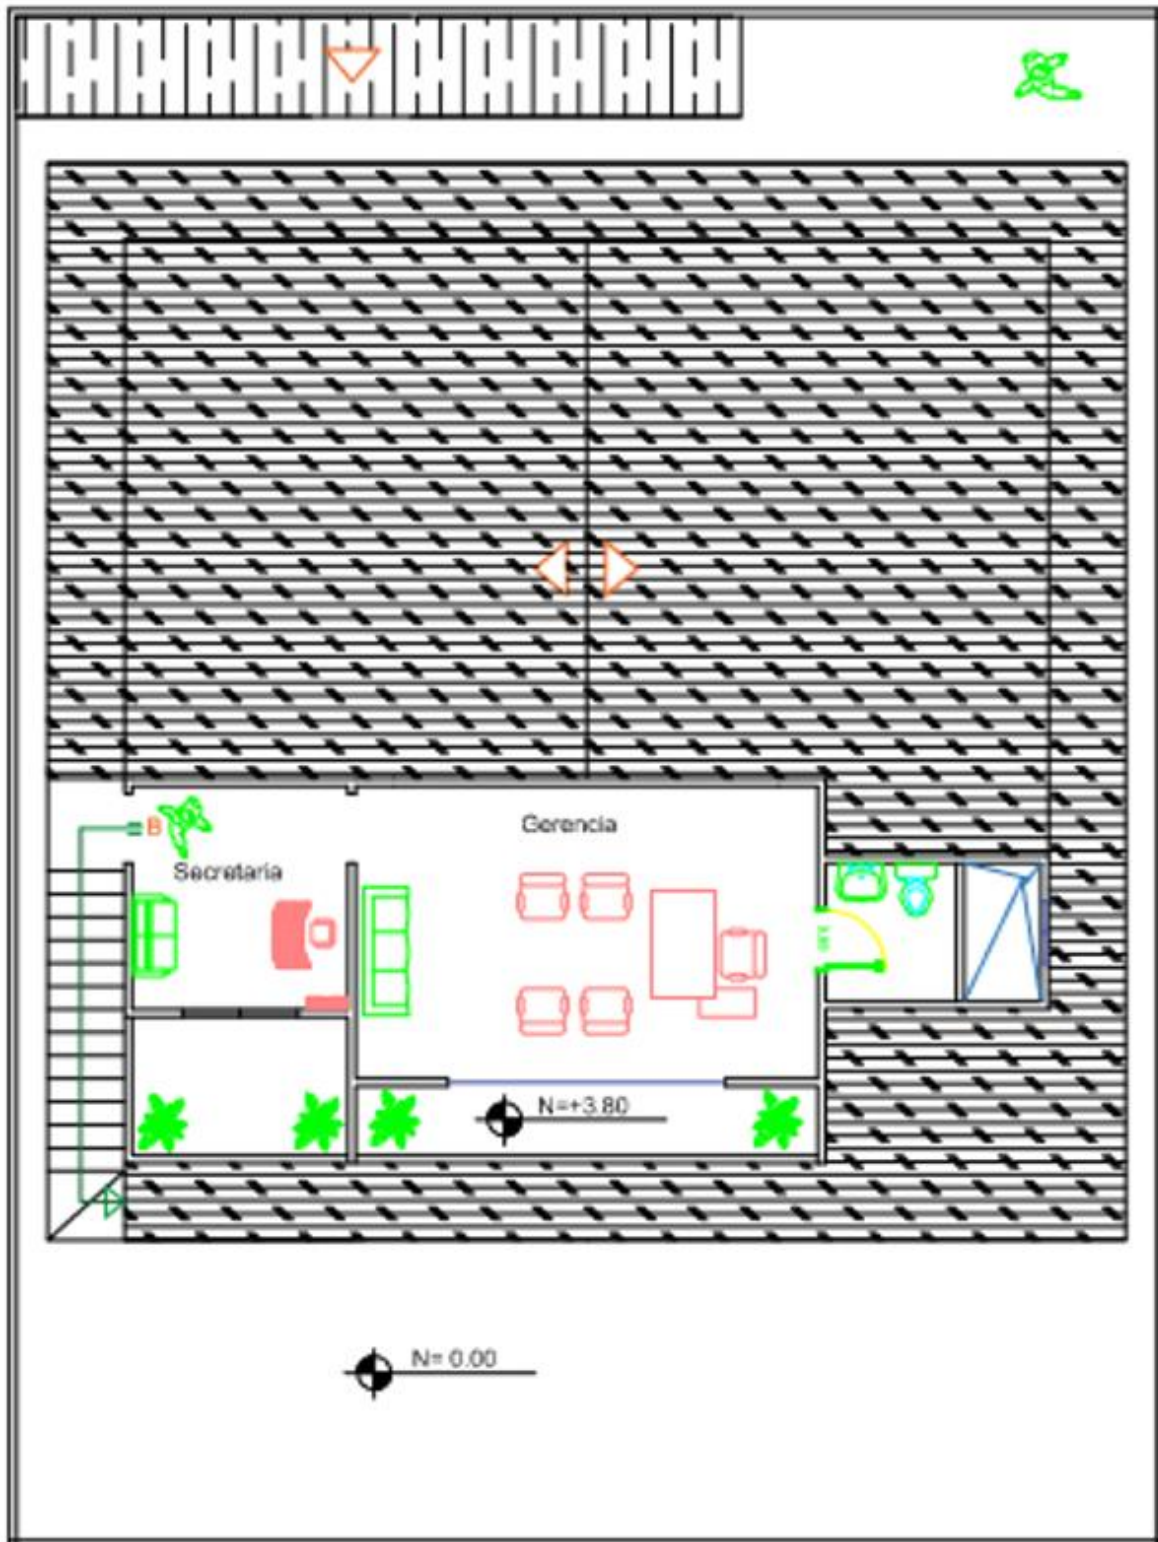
Implantación arquitectónica de planta Goya Green S.A.
